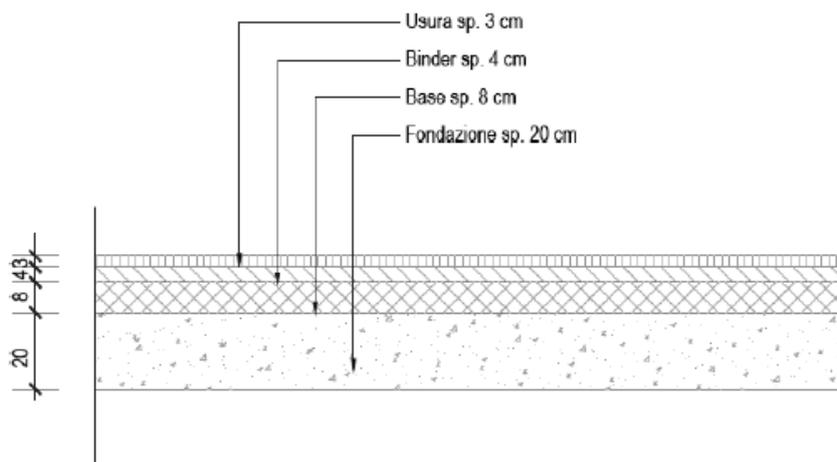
Dettaglio pacchetto di pavimentazione NV05
